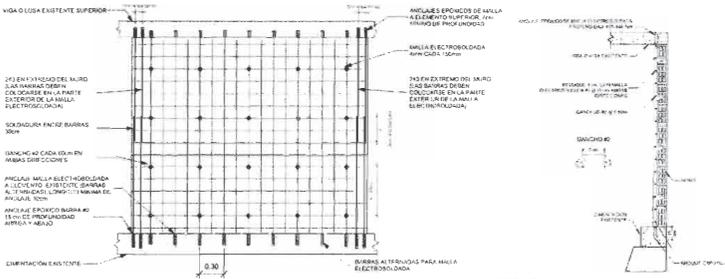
Conexión de muro nuevo a losa maciza existente.
